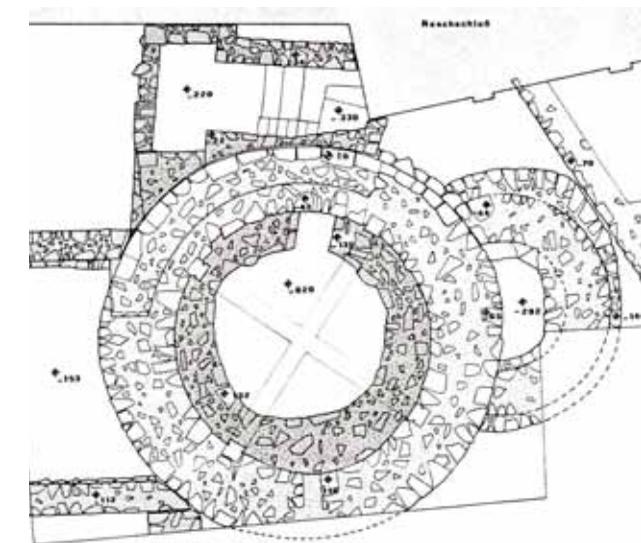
Grundriss des freigelegten Untergeschosses in Eggenburg, Melzer 1978.
